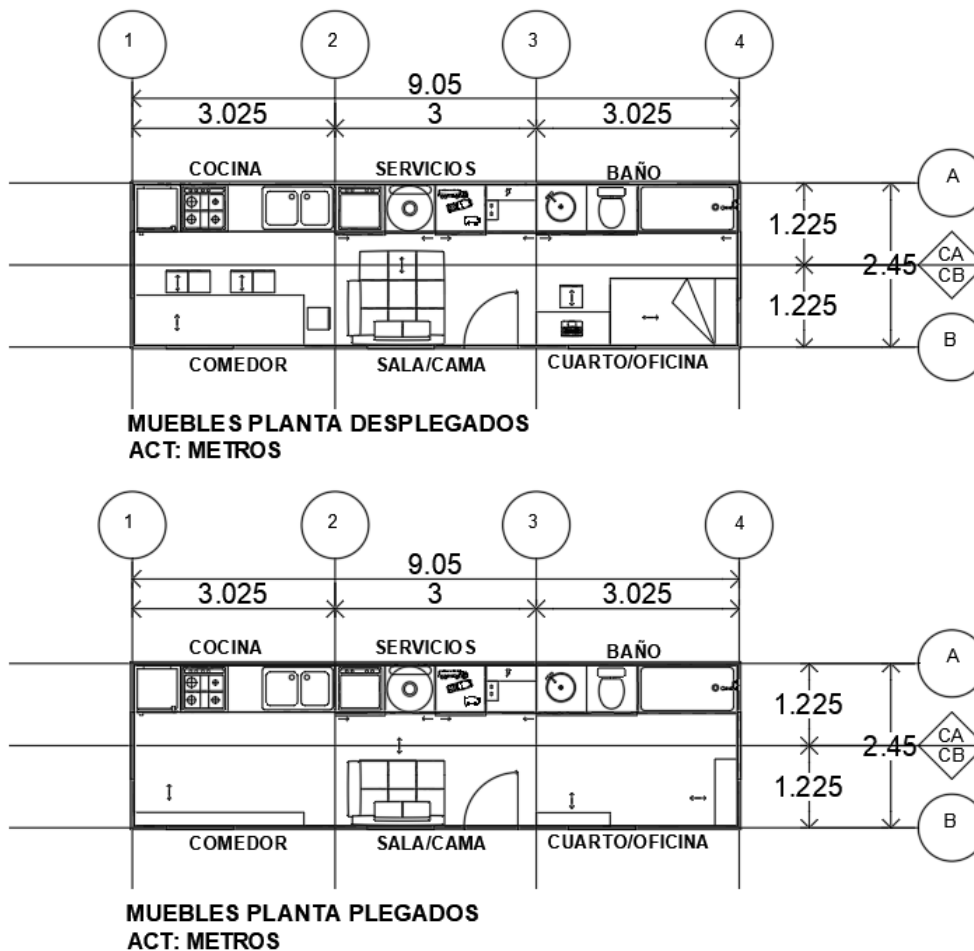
Planta muebles (Elaboración propia, 2023)
